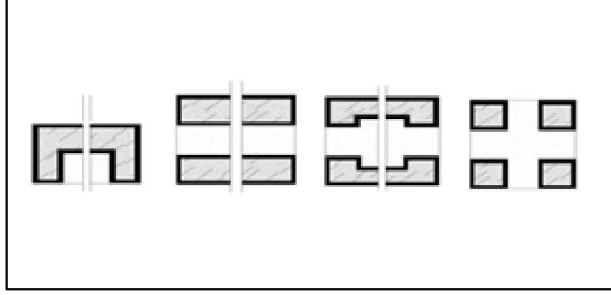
Dış sofalı plan tipi (Küçükerman 1973)
